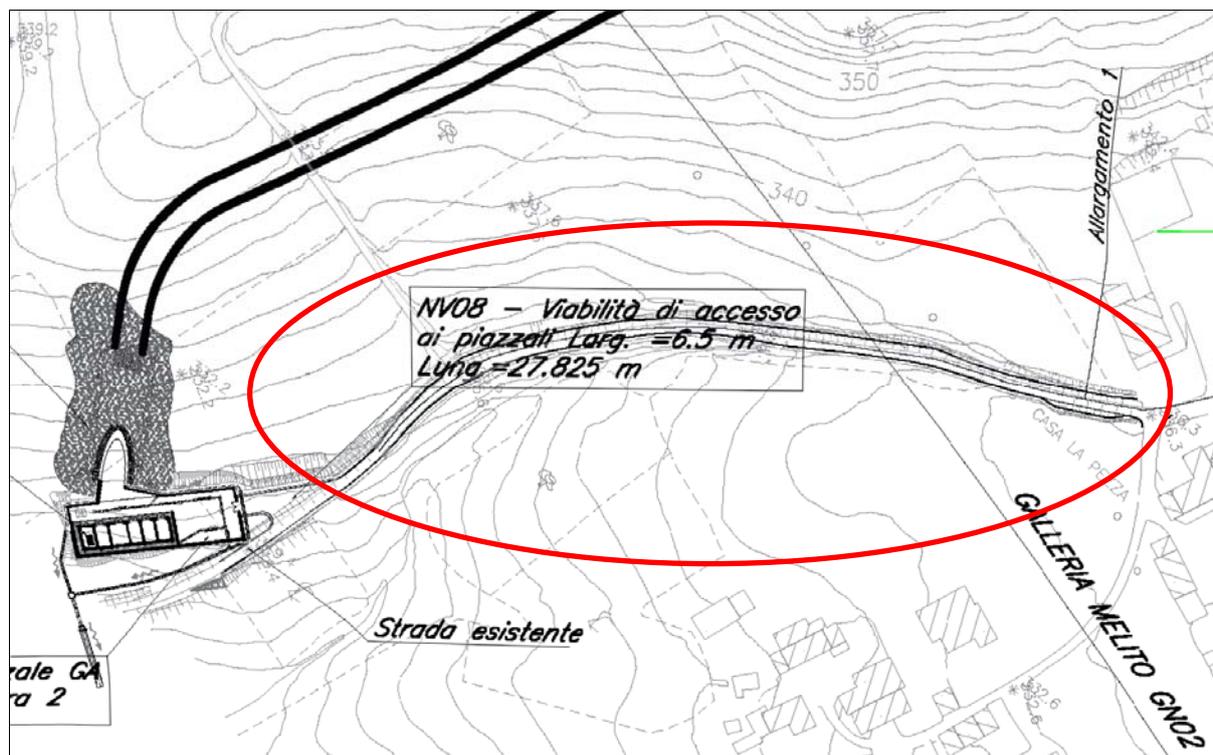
Stralciamento planimetrico con l'individuazione dell'intervento
